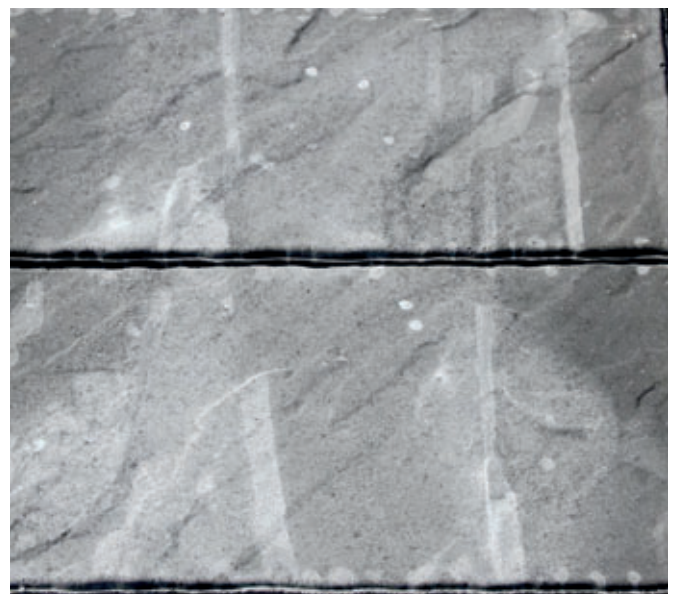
Folgen einer falschen Lagerung von Betonprodukten auf der Baustelle
